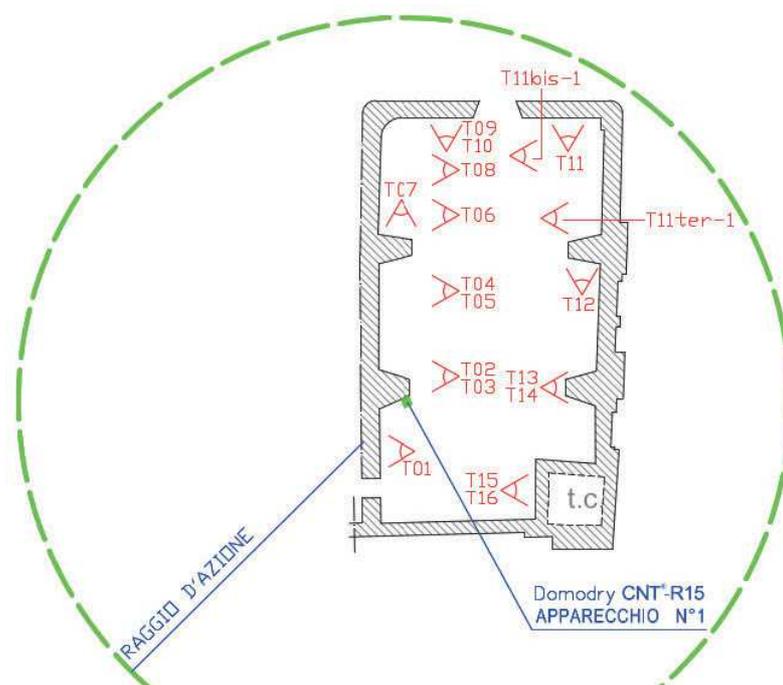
Schema planimetrico del dispositivo CNT installato nel maggio 2013
